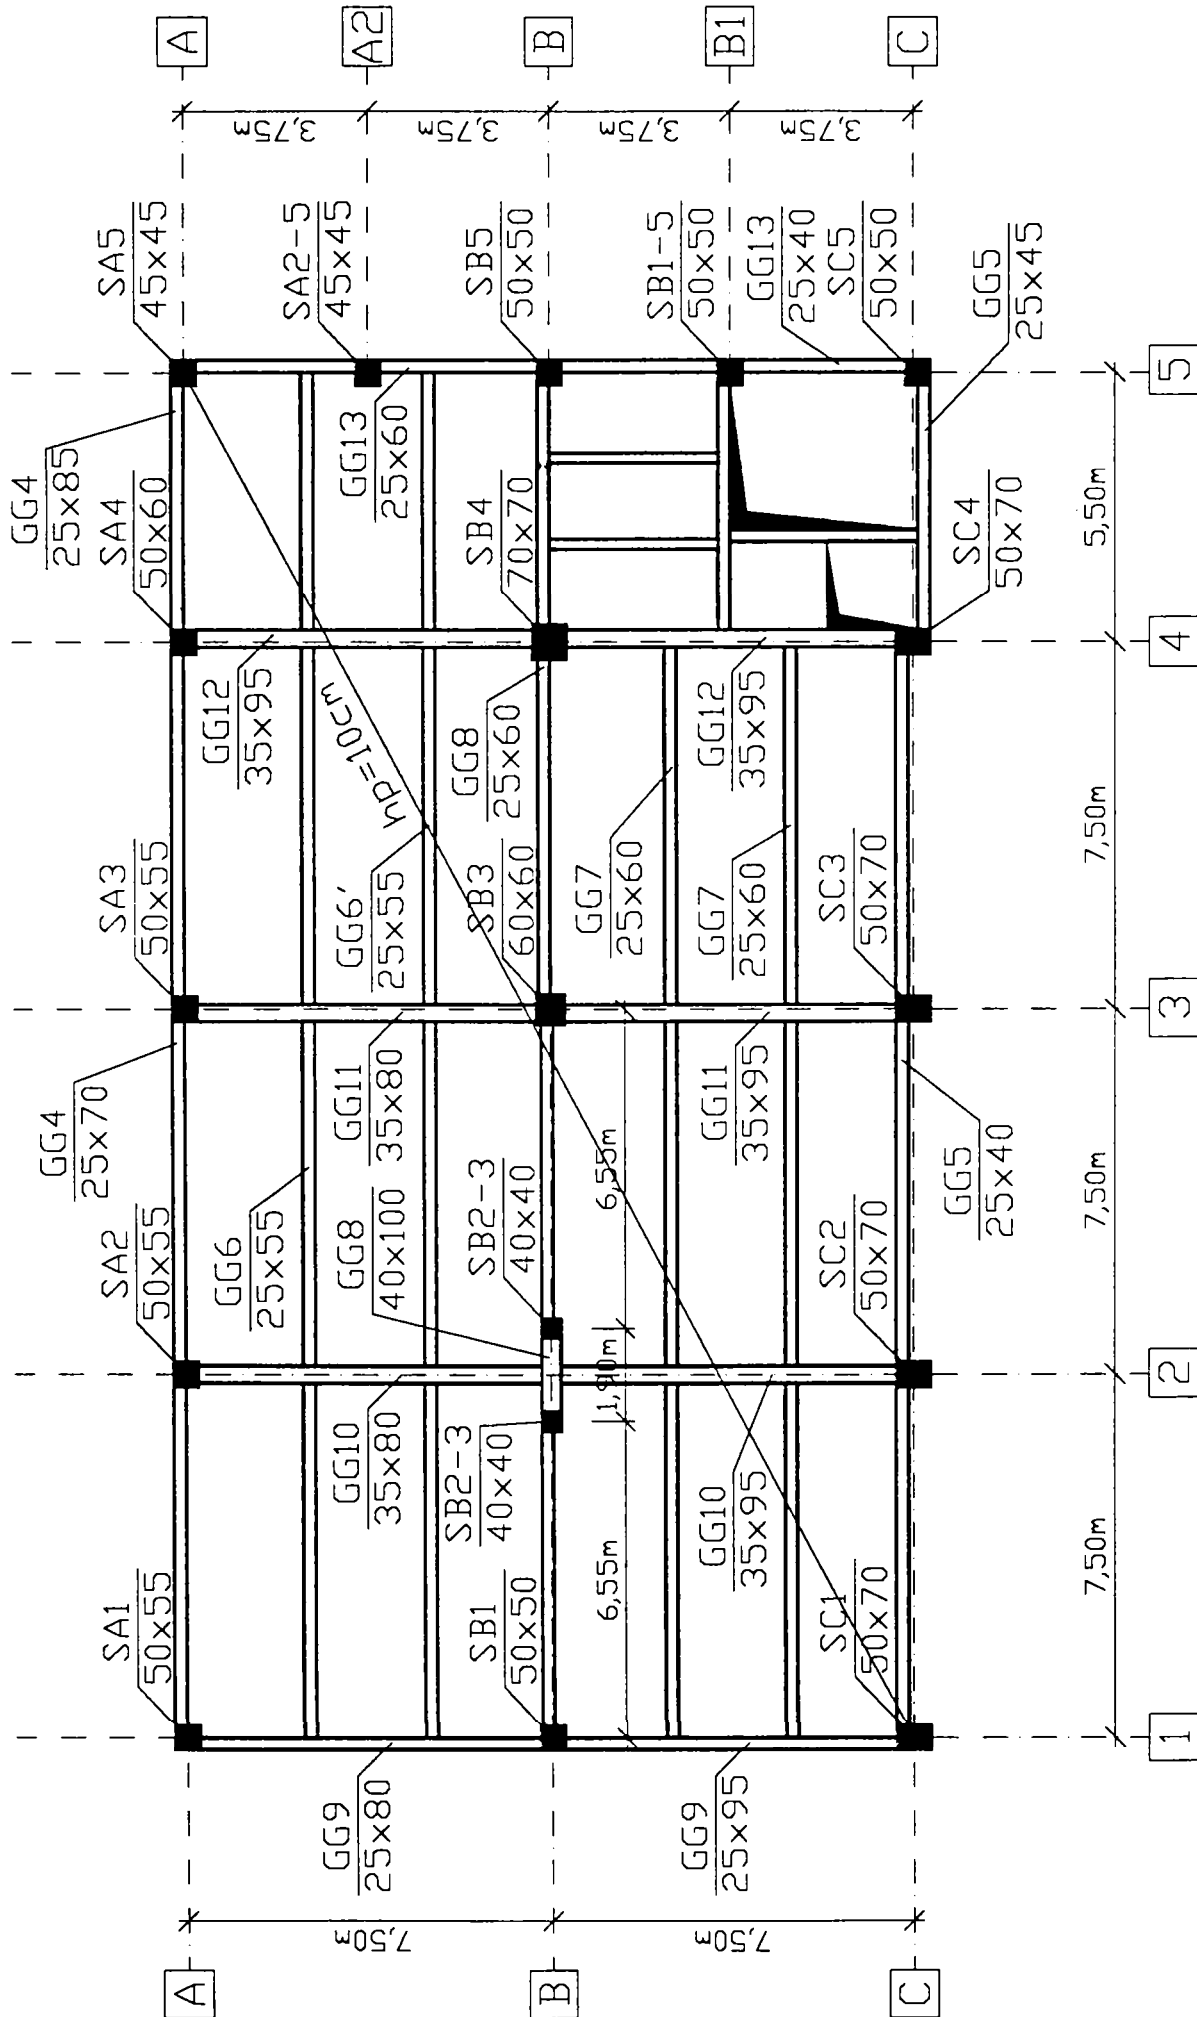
Planșeu cota +10,80 m - plan cofraj.
